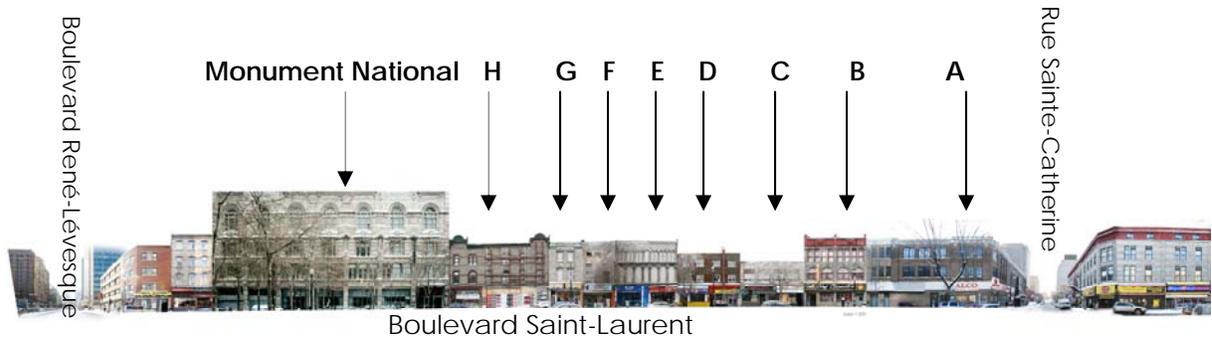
Coupe sur le boulevard Saint-Laurent (Source : Aedifica)
